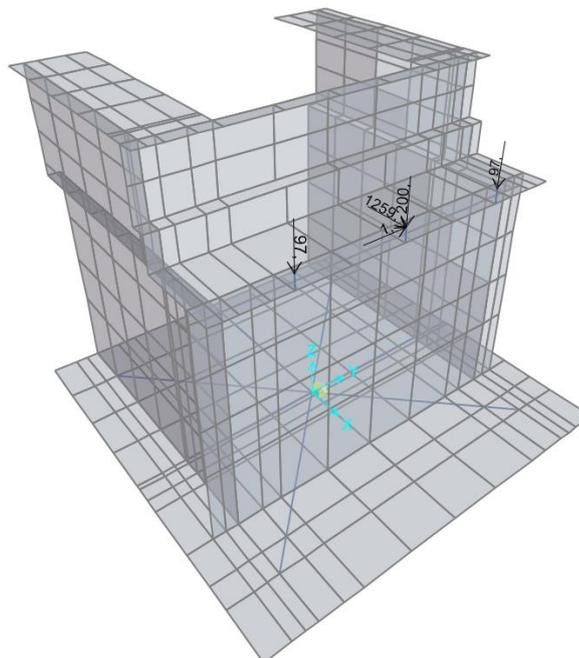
Modello FEM Finale – Vista assometrica carichi sismici in direzione x trasmessi dall'impalcato su spalla fissa (Imp_sis_X)
